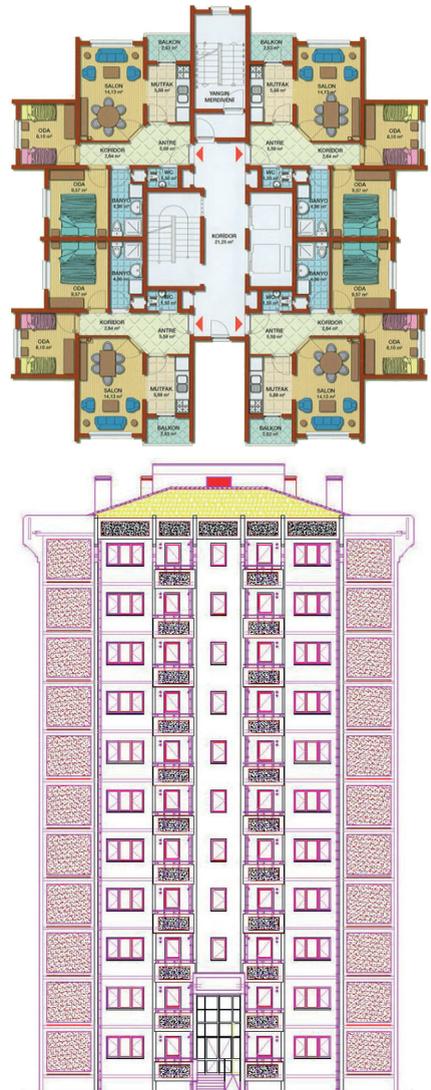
Grundriß, Toki Halkalı-Istanbul
